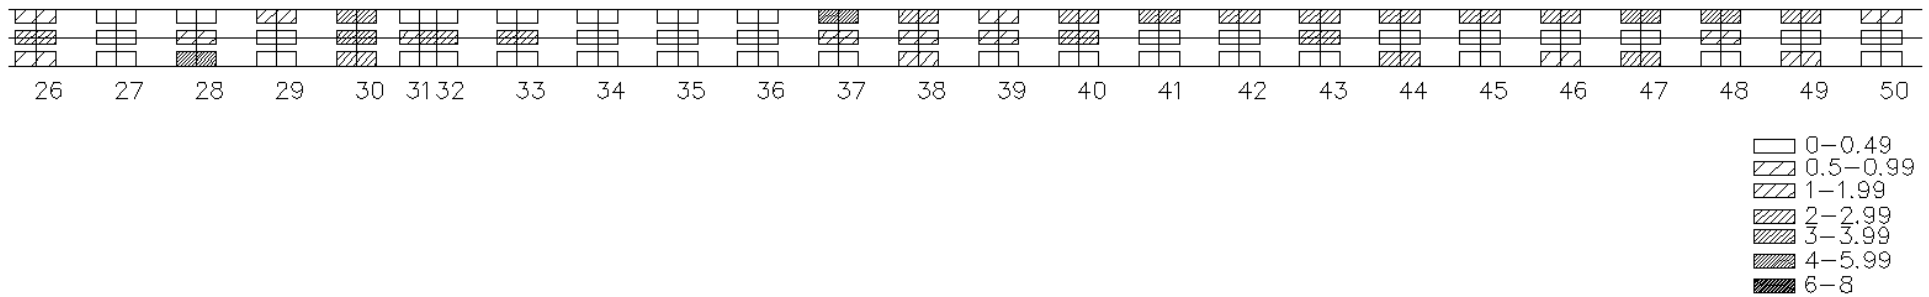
Frästiefen bei kubischer Splinefunktion und Verfahrensplan Typ C, Grundriss, Stationen 26-50
